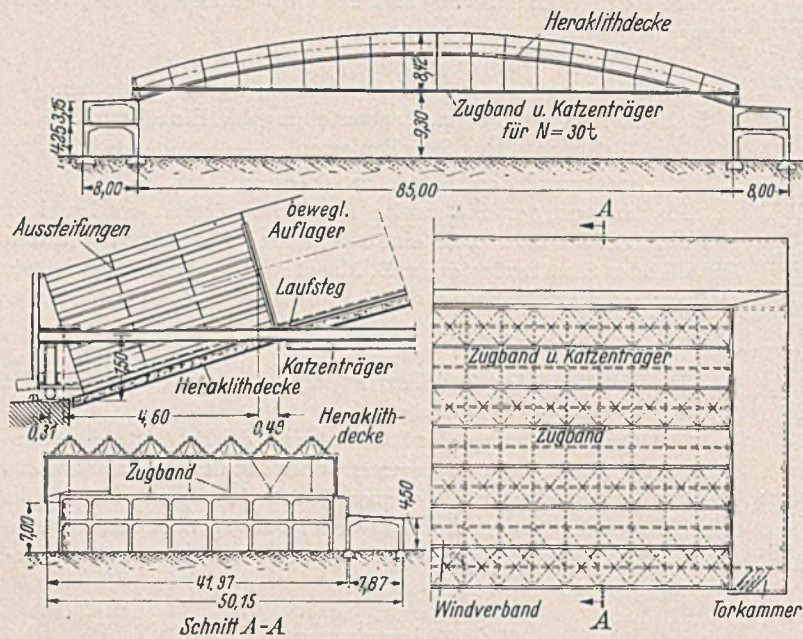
Halle STAHL und EISEN auf der Ausstellung „Schaffendes Volk“. Ausführung Dortmunder Union Brückenbau A. G., Dortmund.
